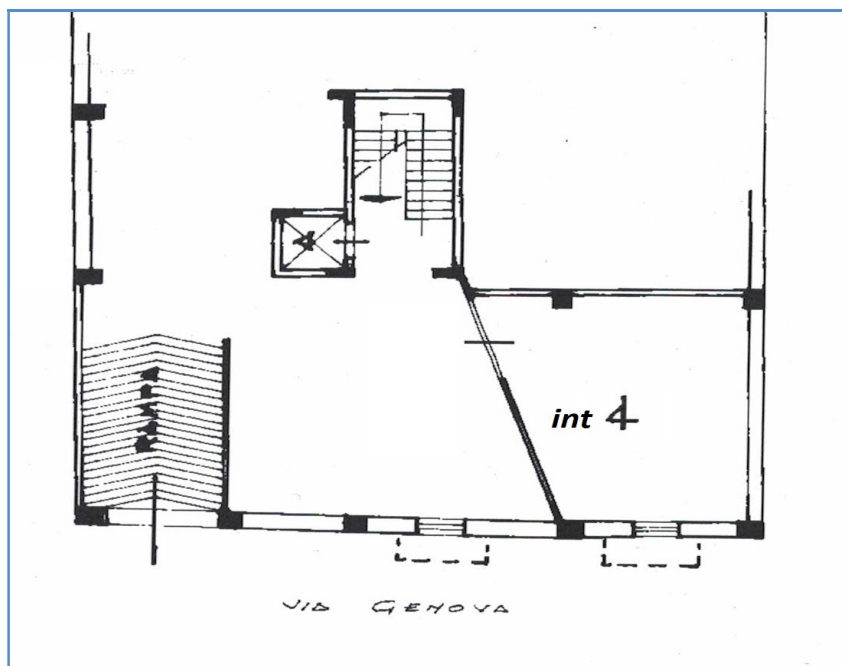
Rappresentazione planimetrica del locale rimessa al piano interrato e dell'area di manovra (disegno non in scala)
